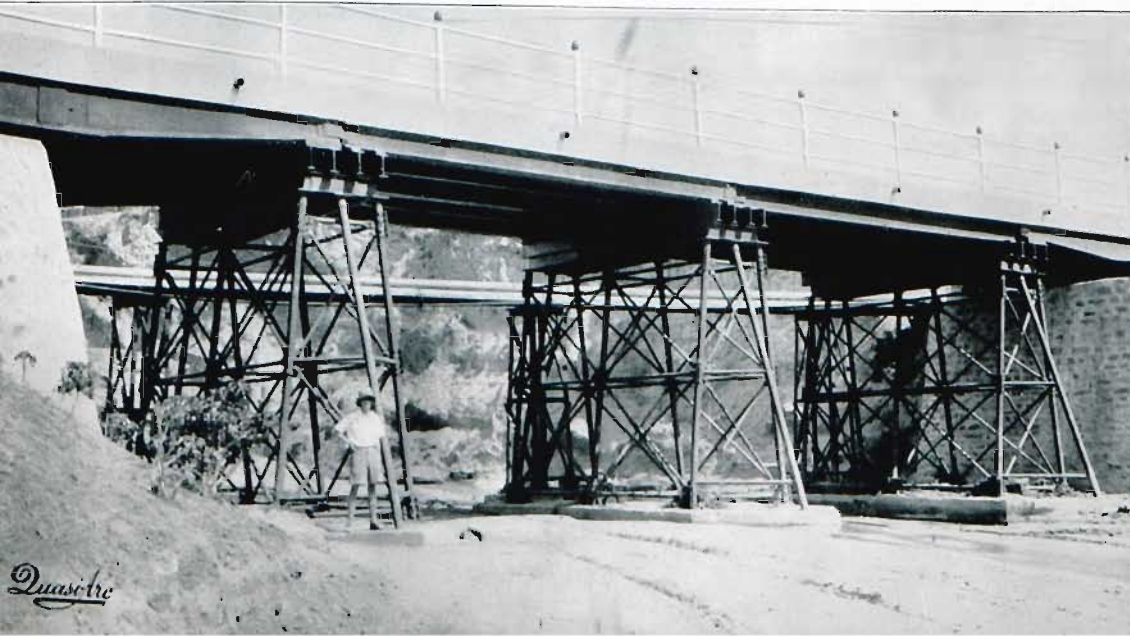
Pont route de Khodaung à Burma, Indes. Les piles sont formées de tubes métalliques assemblés par soudure. (D'après la revue *Electric Welding*.)
